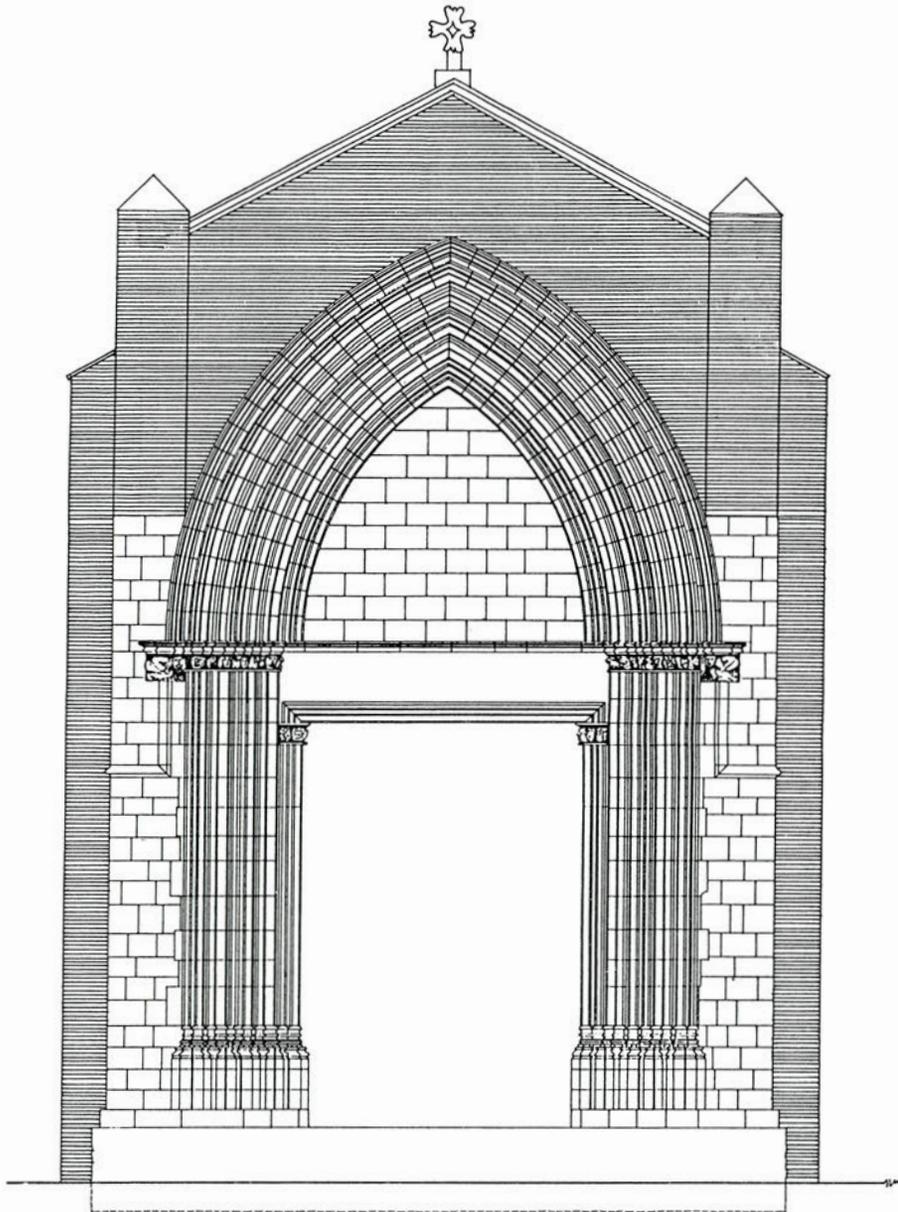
Alzado frontal del proyecto de restauración de la puerta del Carmen elaborado en la Cátedra Gaudí.
